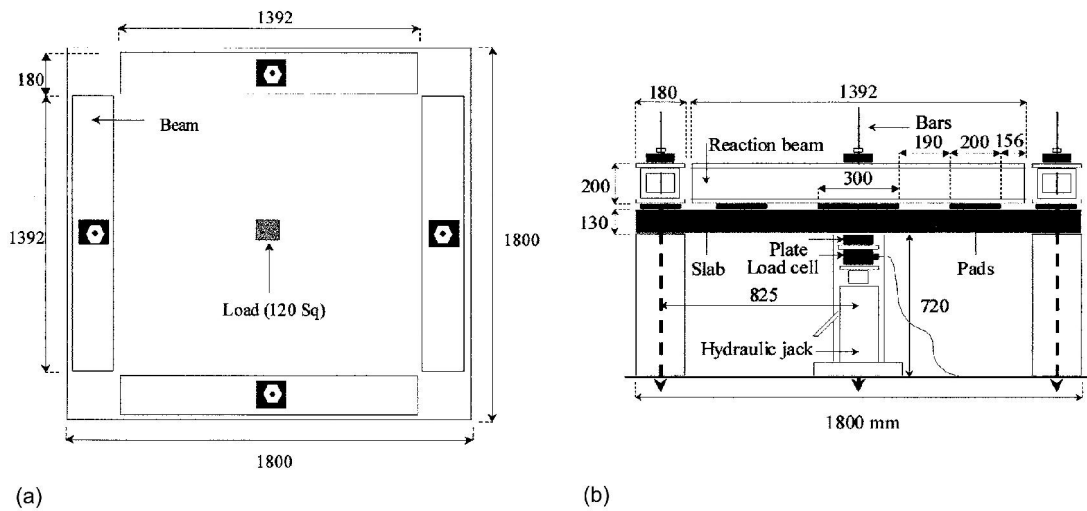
Sistema de ensaio: (a) Vista em planta; (b) Vista em alçado [53].
